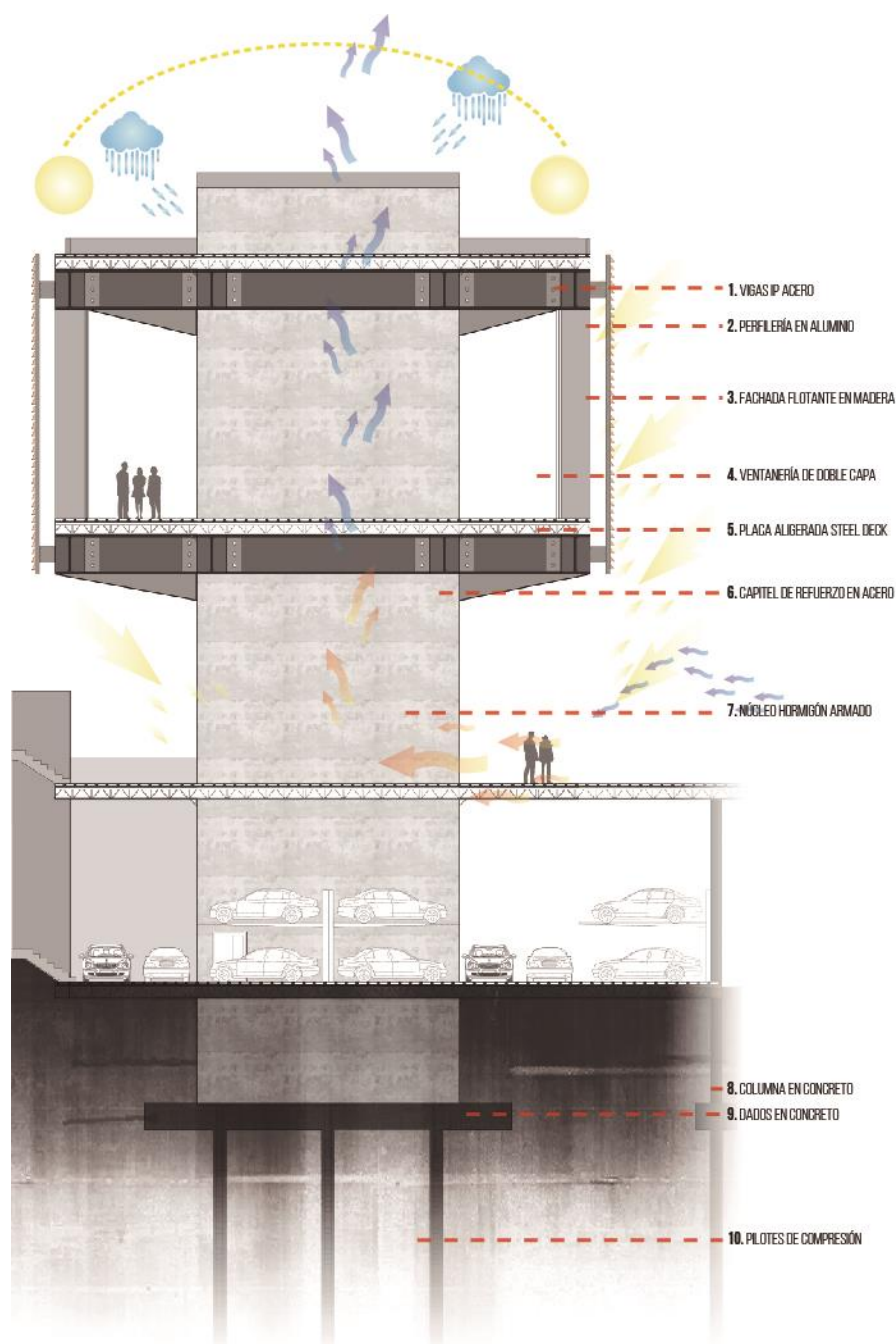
Autor: Elaboración propia. (2018). *Corte fachada.
